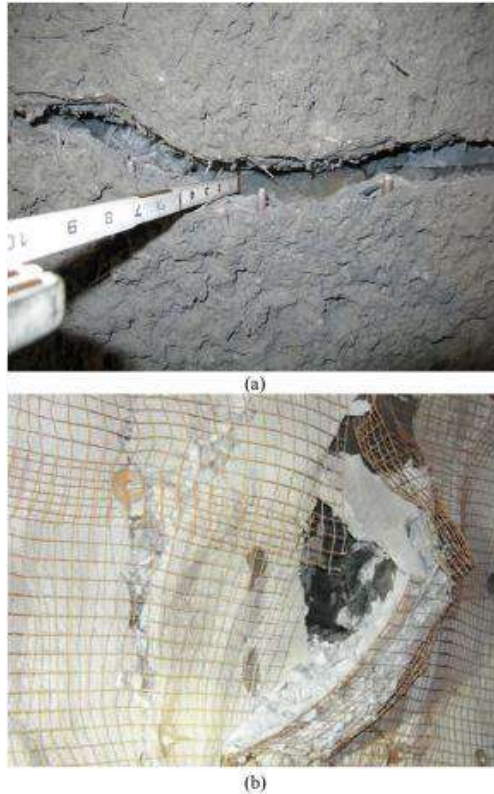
Состояние набрызгбетонной крепи после ее разрушения: а – с сеткой в набрызгбетоне; б – с сеткой поверх набрызгбетона
